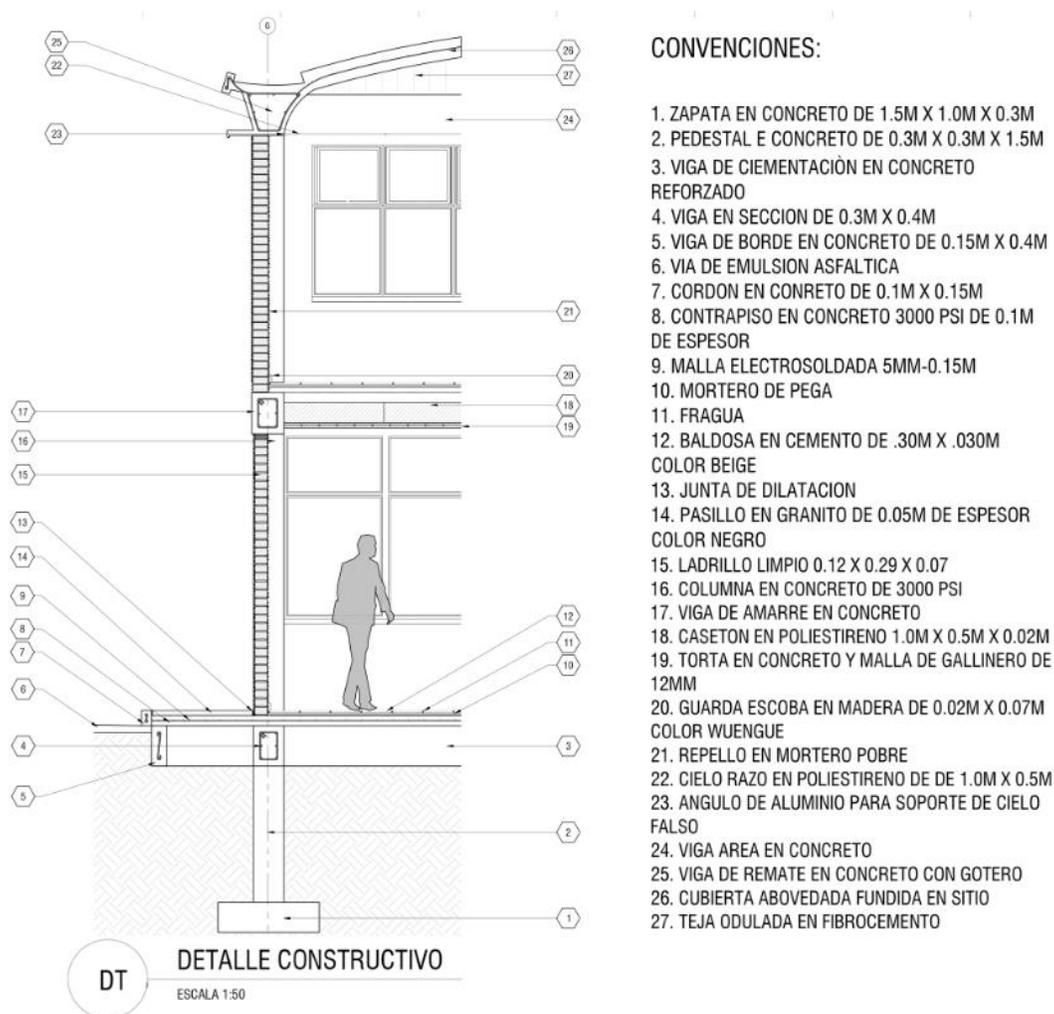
Detalle Constructivo Estructura Edificio CDTI.
